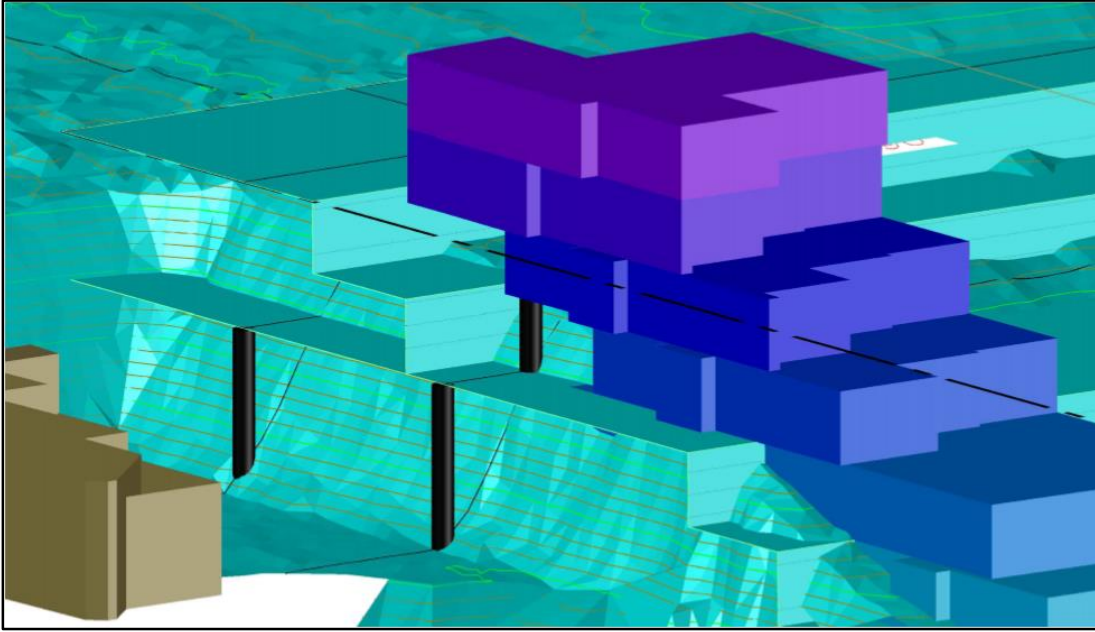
Modelo tridimensional con la ubicación de las pilas y pilotes.
